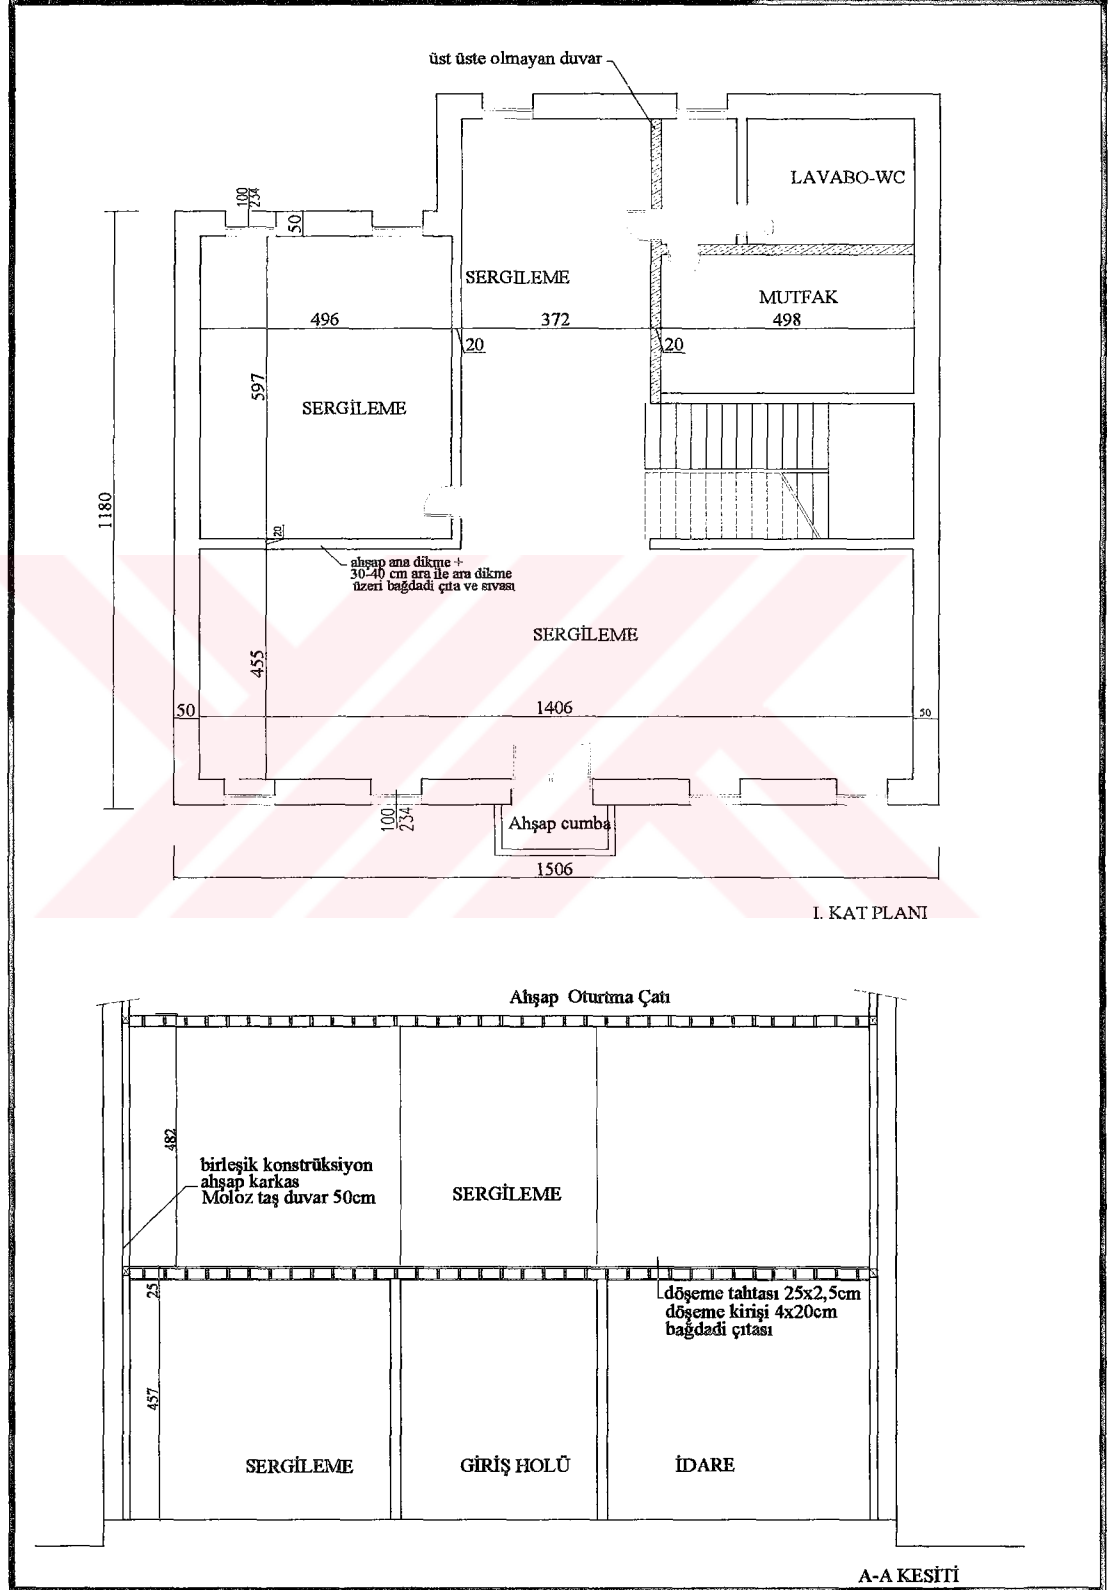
Murat Köşkü kesit ve döşeme detayı
